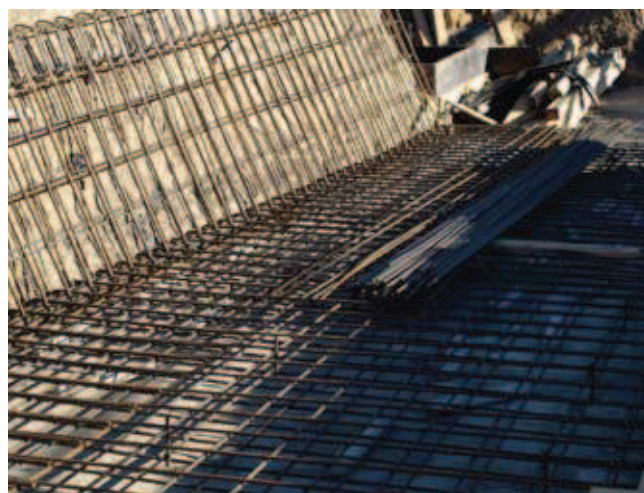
Uzupelnione spoin – fragment mostu w strefie pierwszego przęsła
